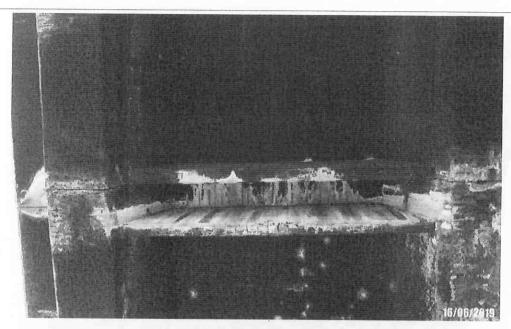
Detalhe de armadura da fe ceinferior exposta e lixiviação.
